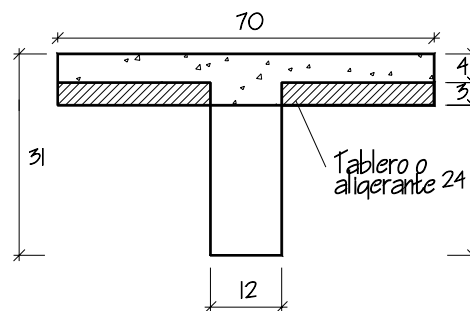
Sección transversal optimizada, prácticamente los 4cm. de hormigón están en compresión.
